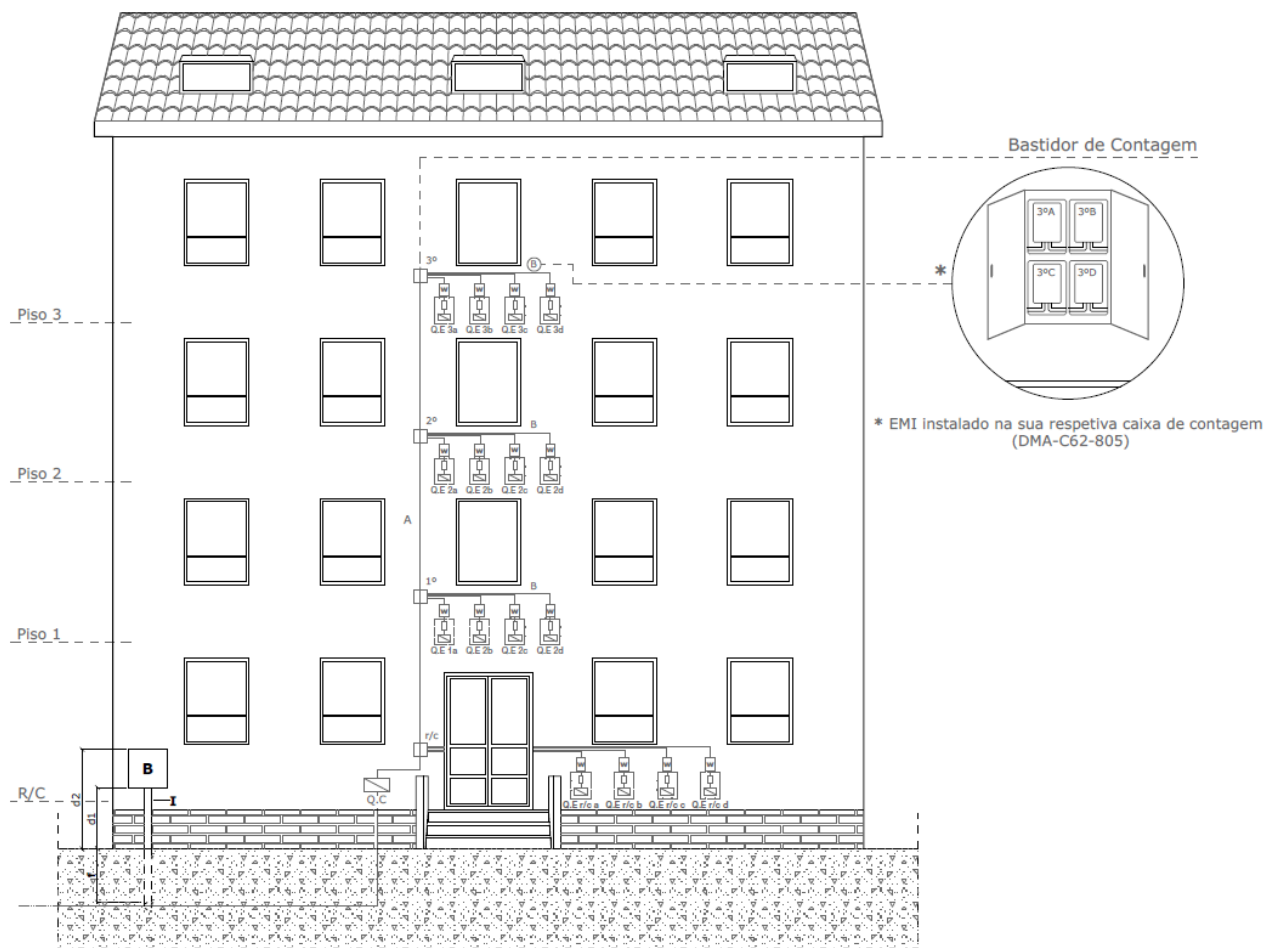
Ligação a partir de rede subterrânea de edifícios coletivos sem muro (portinhola na fachada do edifício).
